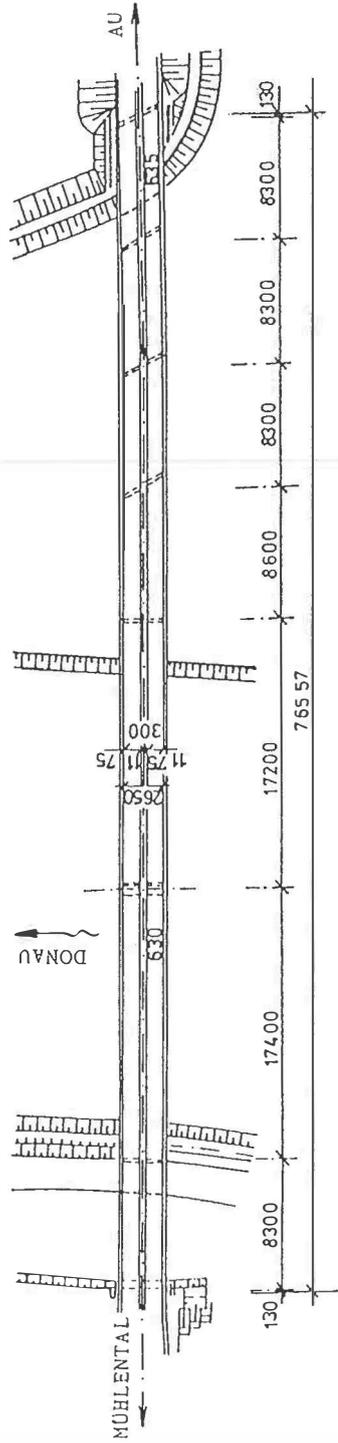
Längsschnitt und Grundriß des Hauptbrückentragwerks
